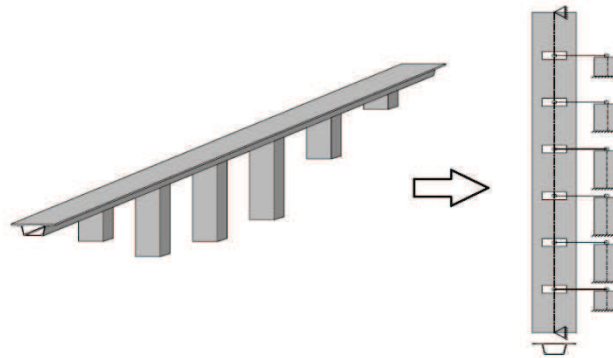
Esquema da modelação estrutural com modelo plano. [4]
